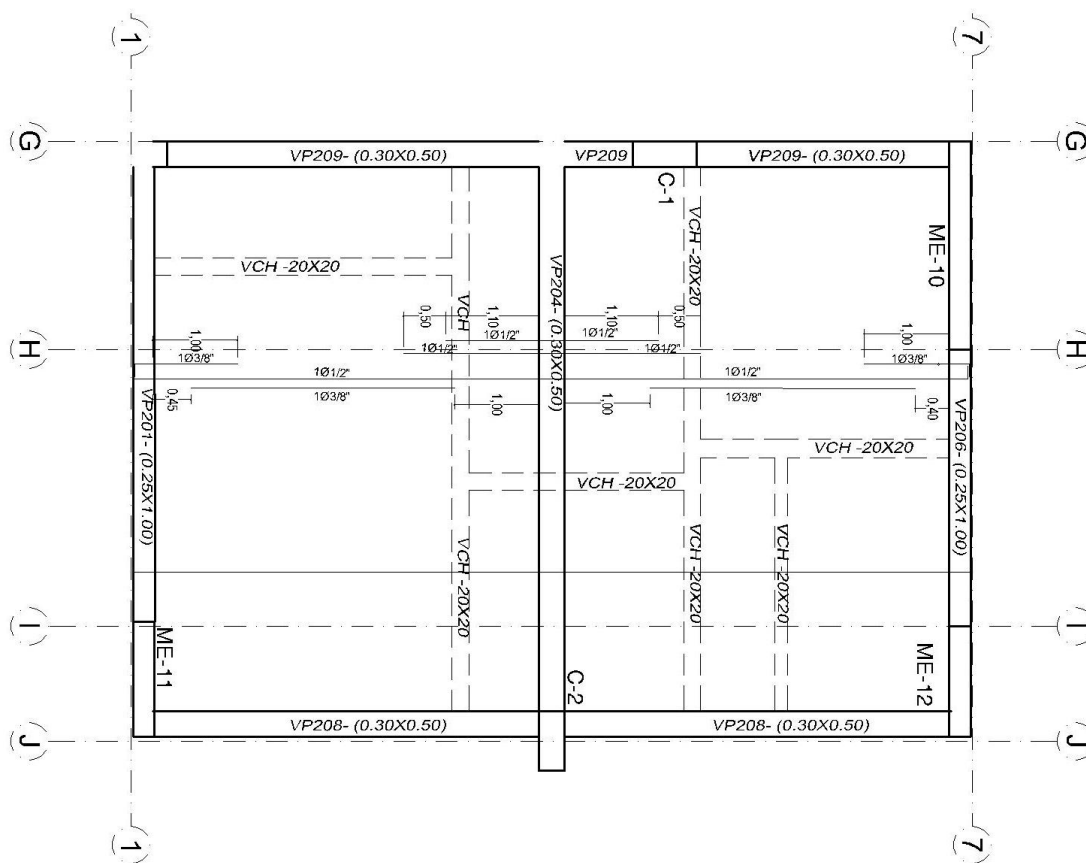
Distribución final del refuerzo en la losa aligerada analizada.
